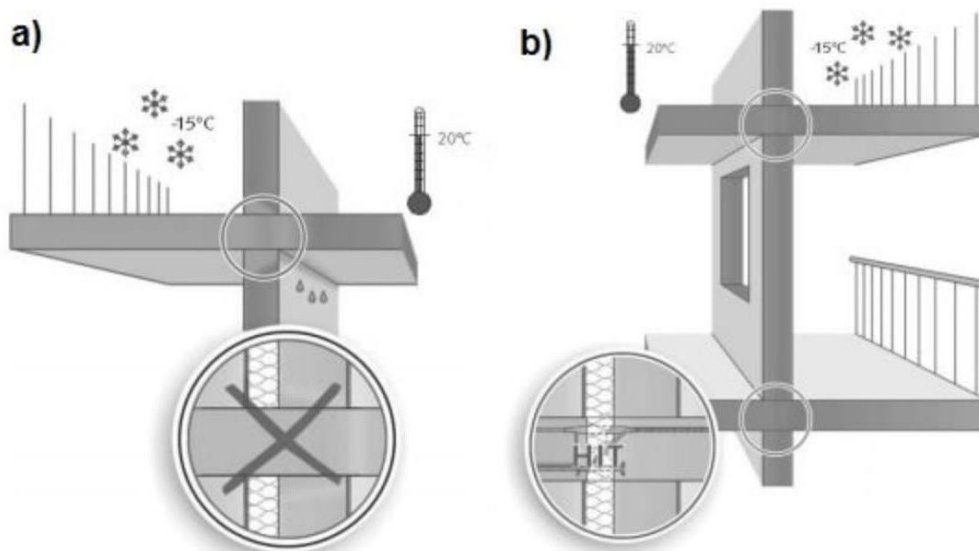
Soluție de instalare a panourilor de balcon fără punte termică.
